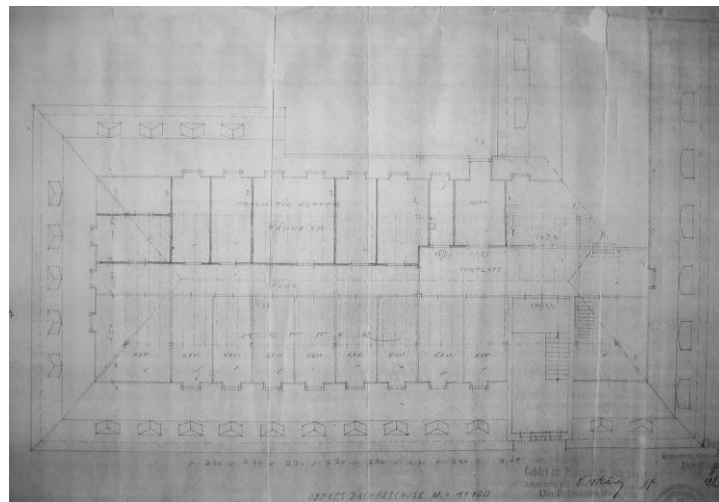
Oberes Dachgeschoss, 12.05.1927
